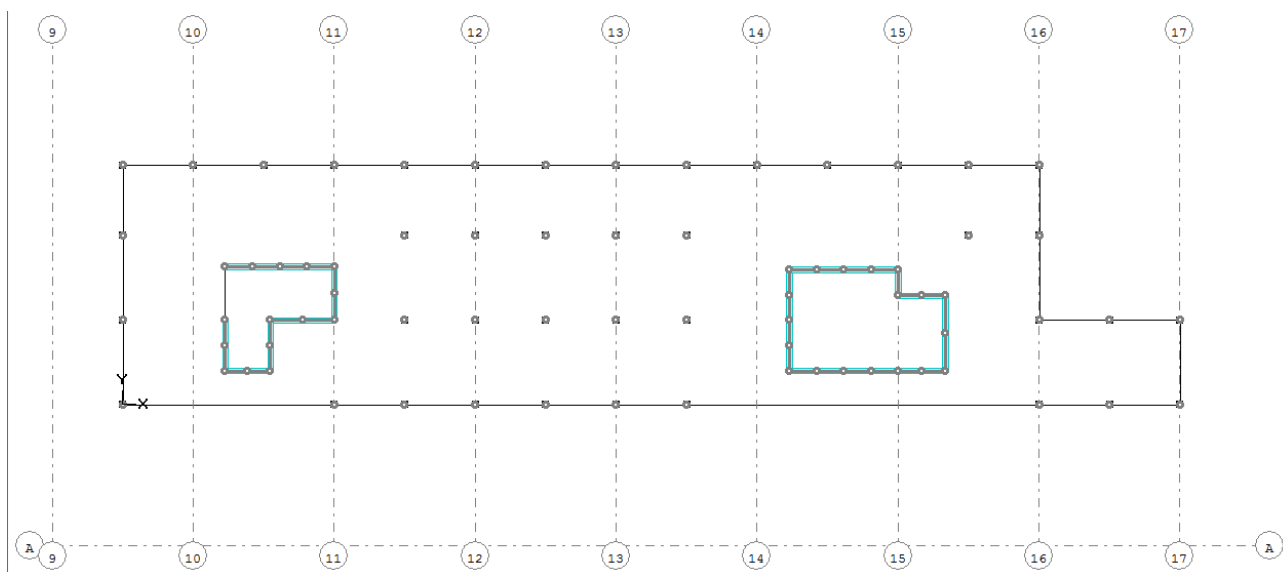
Опалубкове креслення плити перекриття на відмітці +14,500
